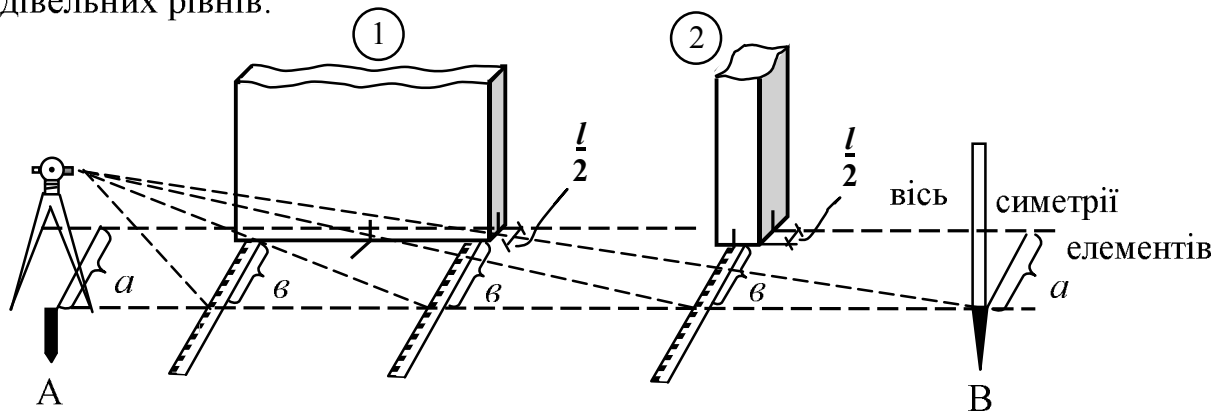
Схема способу бокового нівелювання: 1 – монтаж панелей; 2 – монтаж колони
